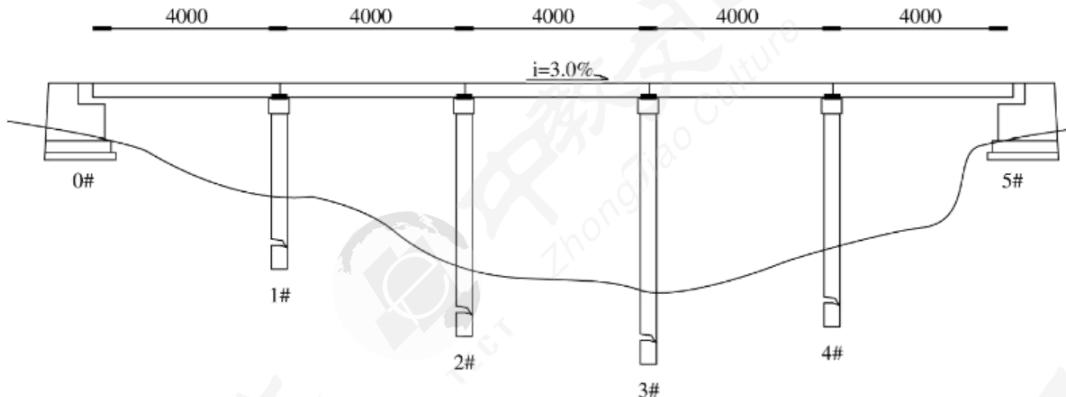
某简支 T 梁桥立面示意图 (单位 : cm)
